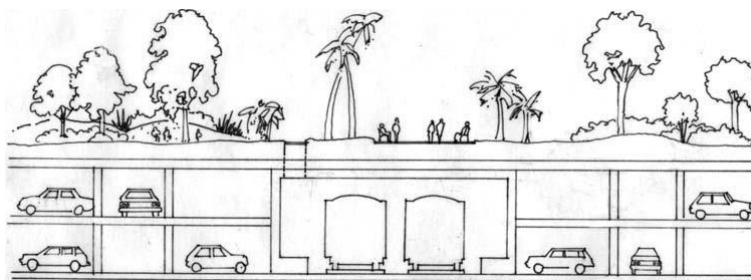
Esquema de coberturas ajardinadas ao nível do solo, sobre parques de estacionamento subterrâneos. Fonte Green Roof Systems - A Guide to the Planning, Design, and Construction of Landscapes over Structure Susan K. Weiler Katrin Scholz-Barthp p.84
